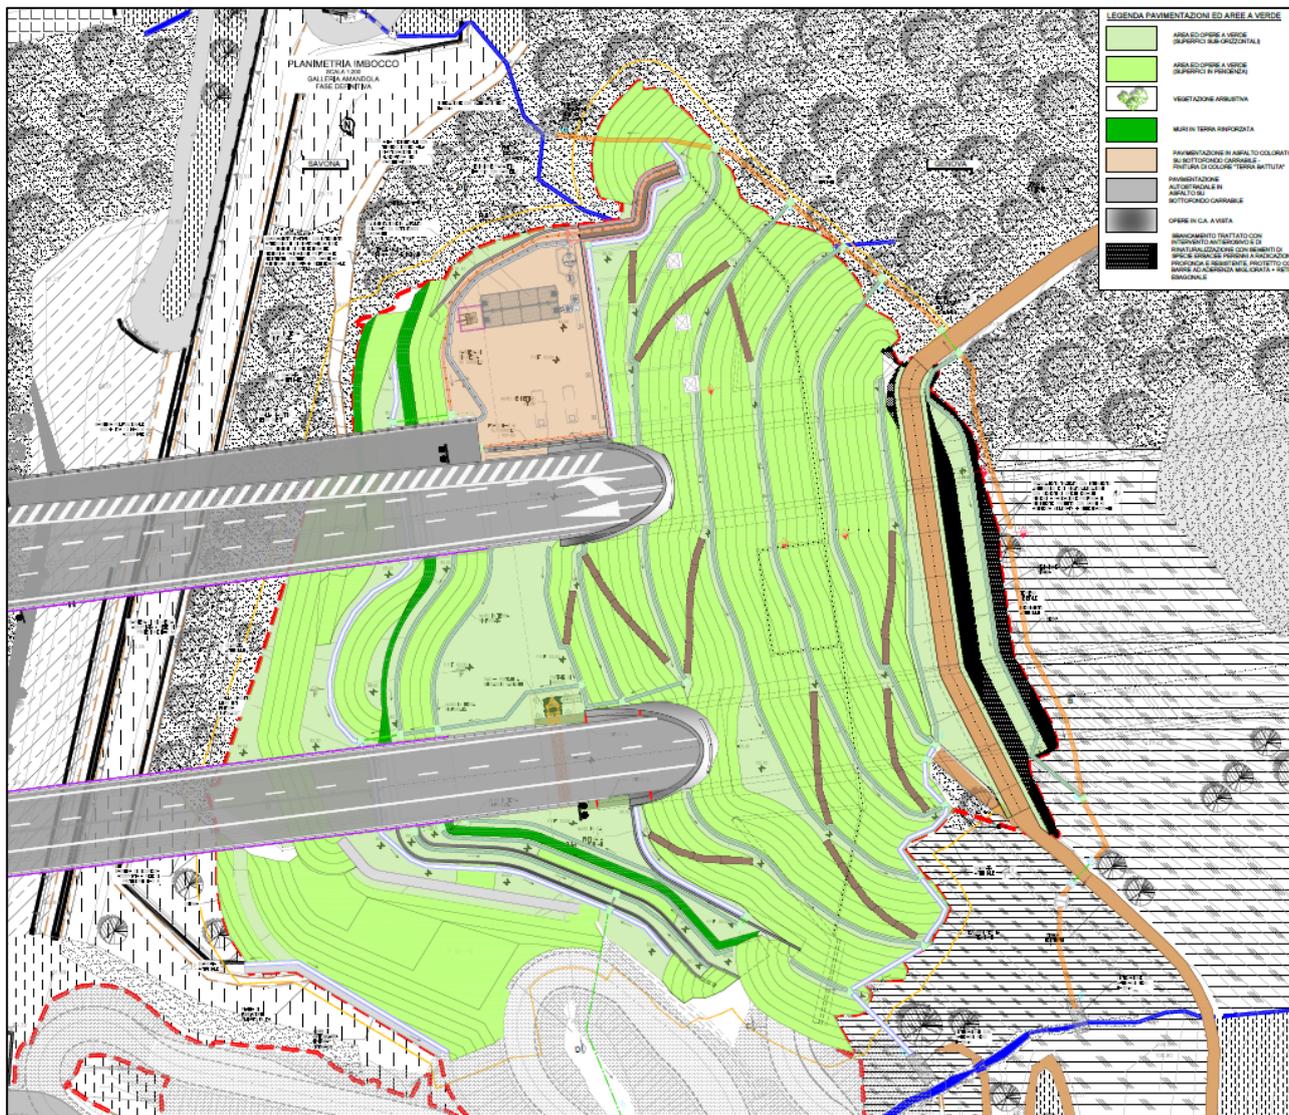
Planimetria stato finale dell'area di imbocco (fonte: elaborato 110728-LL8C-PE-A1-G06-GF06W-SSF00-D-AUA1971-1)
